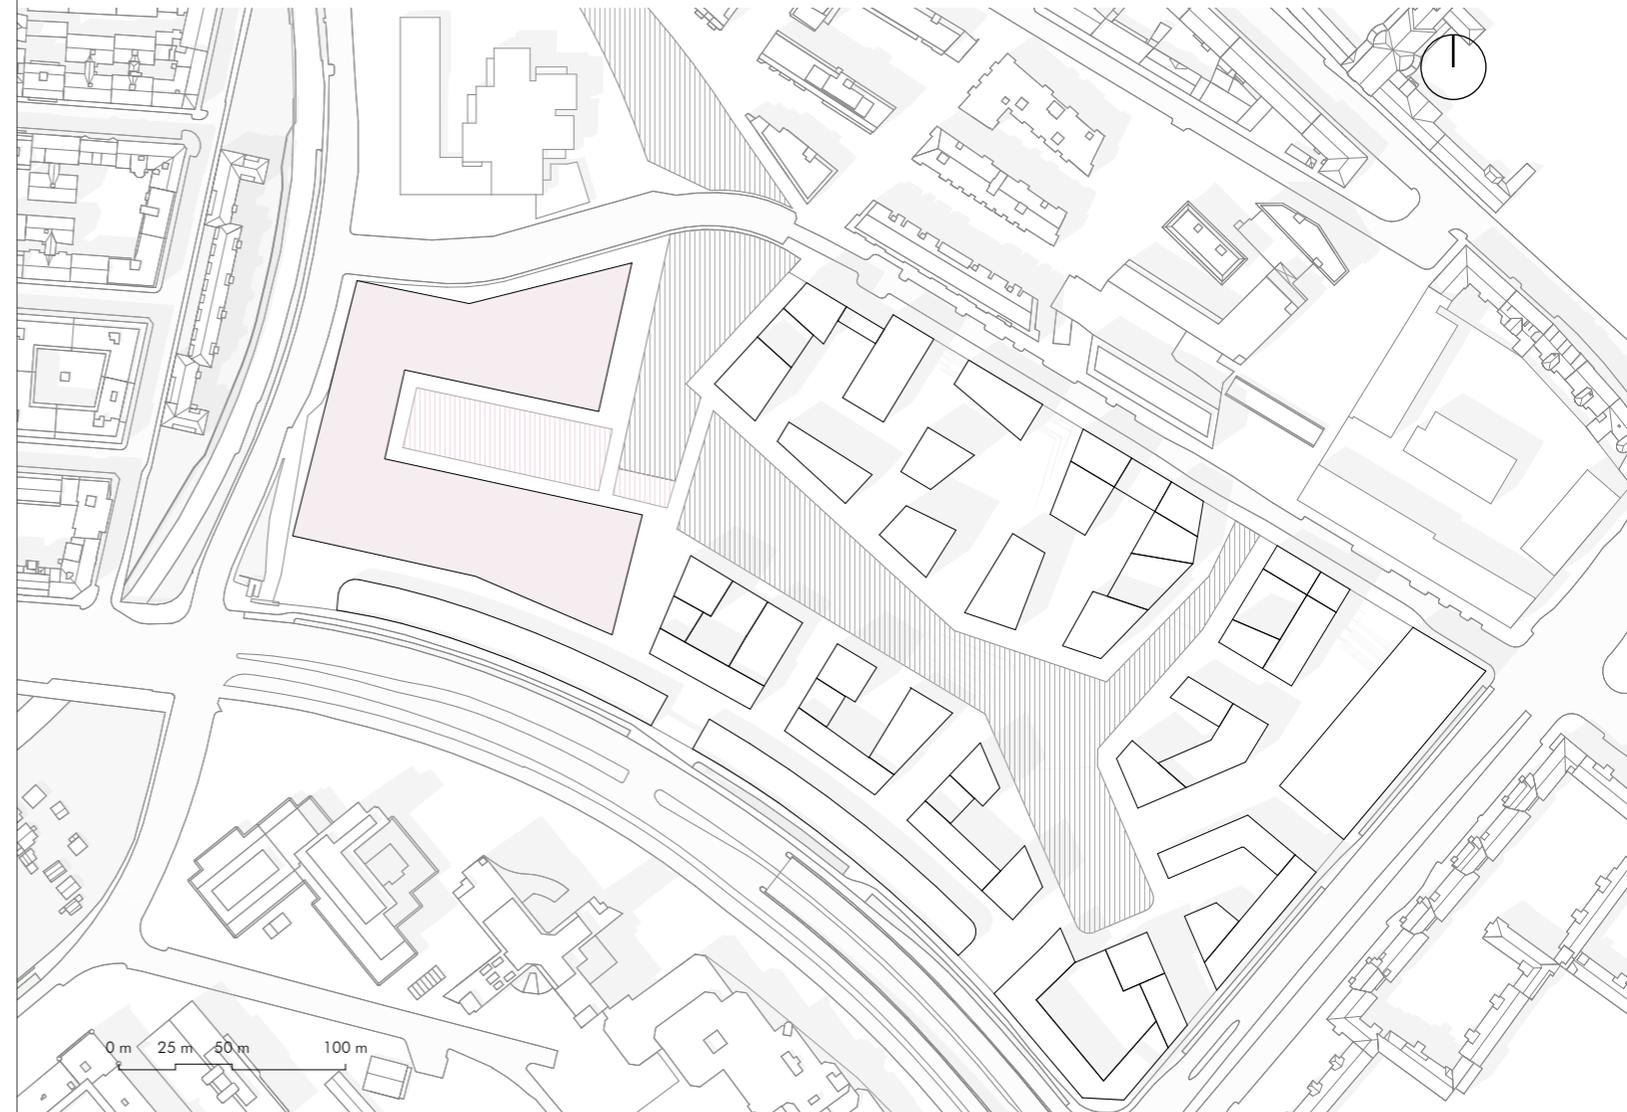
| Lageplan mit dem neu definierten Bauplatz
